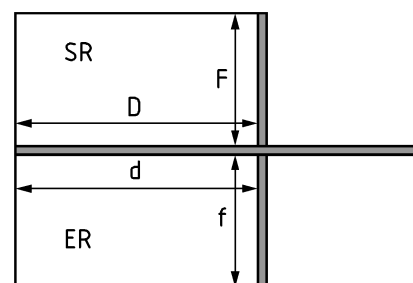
Abgewinkelte trennende und flankierende Bauteile, Grundriss
